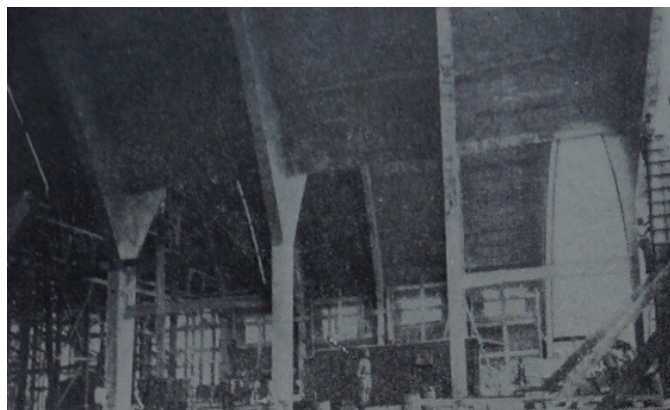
Interior do hangar. FONTE: CONCRETO, 1938.
